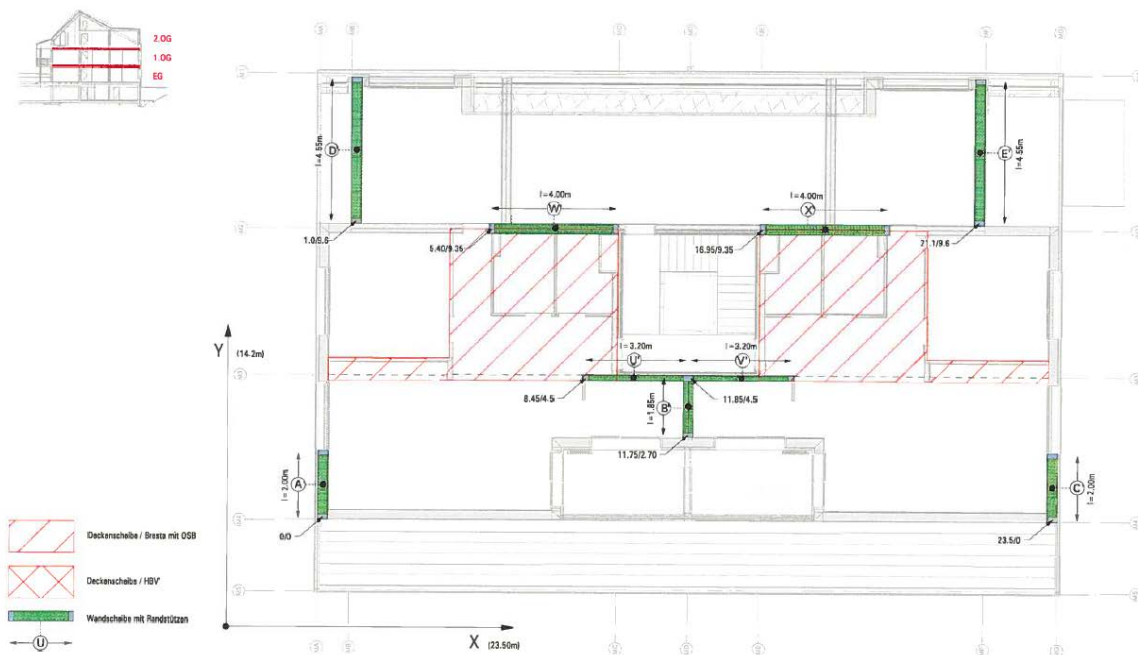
Positionsplan der horizontalen Aussteifung durch Rahmenbauwände im Obergeschoss 2
